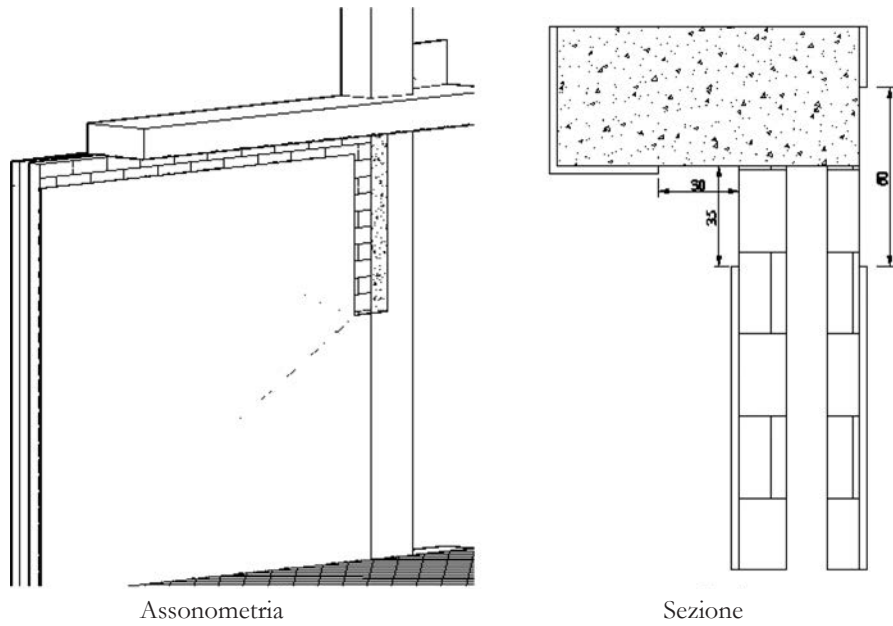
Rimozione dell'intonaco esistente lungo le fasce perimetrali di ancoraggio.
